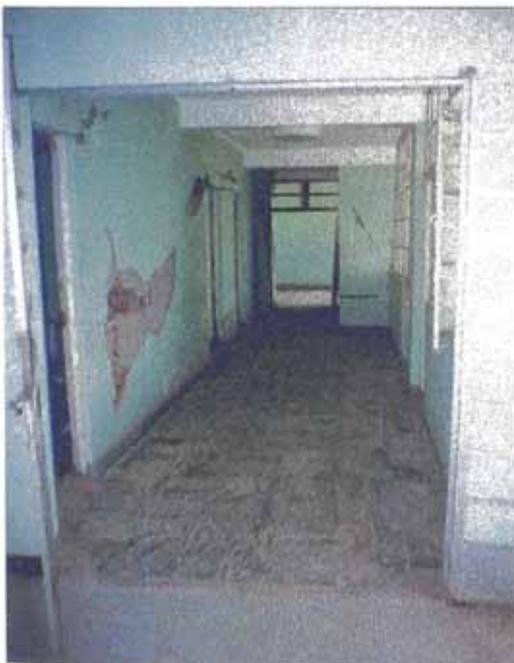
Vista de los ambientes, pasadizo, 2do piso Pabellón A.
